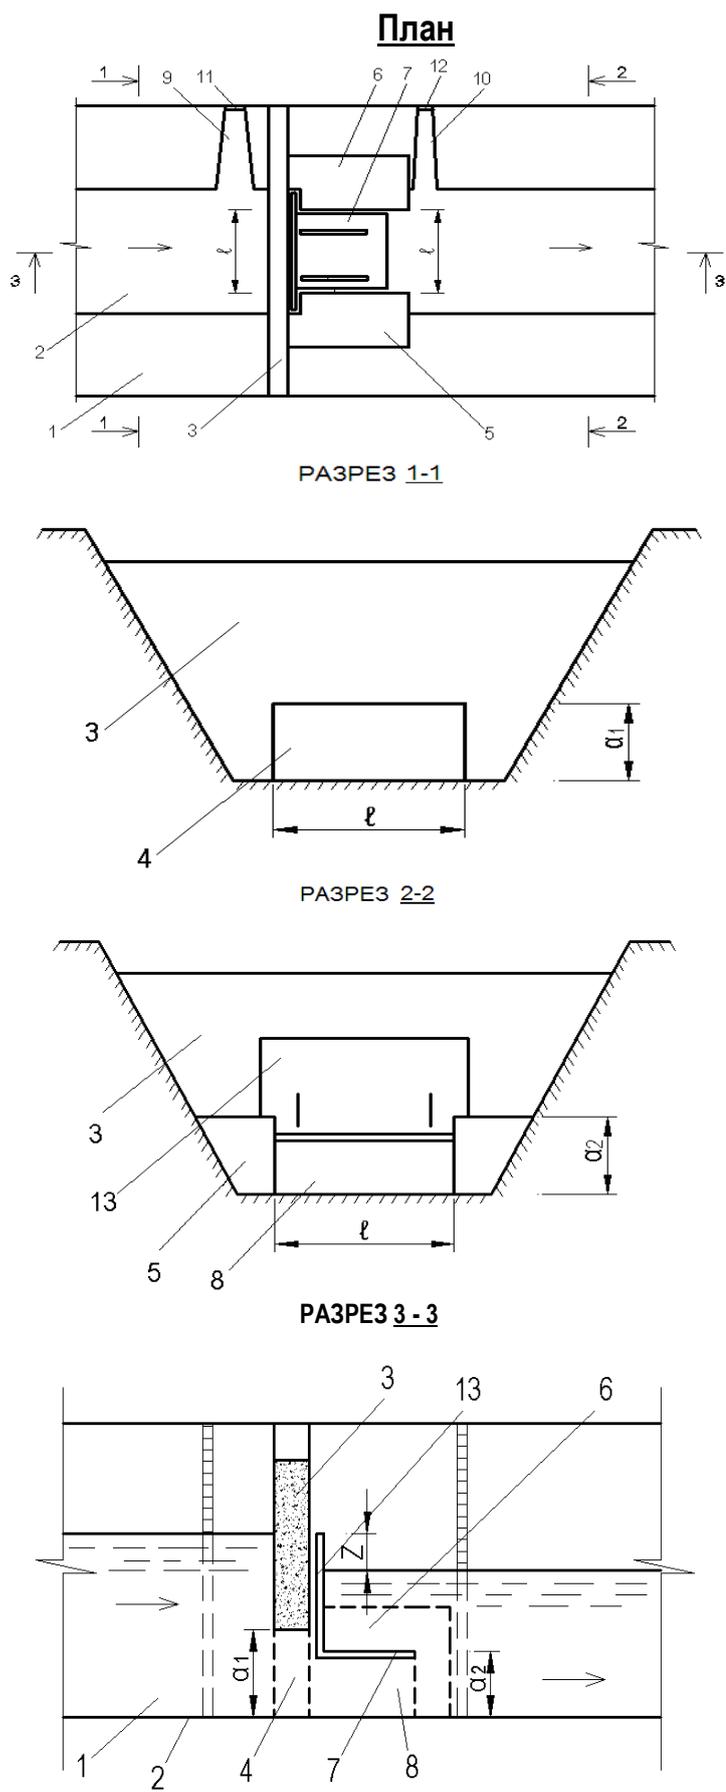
Схема водомера типа «Прямоугольный насадок» применительно водотоку с трапецидальным поперечным сечением
